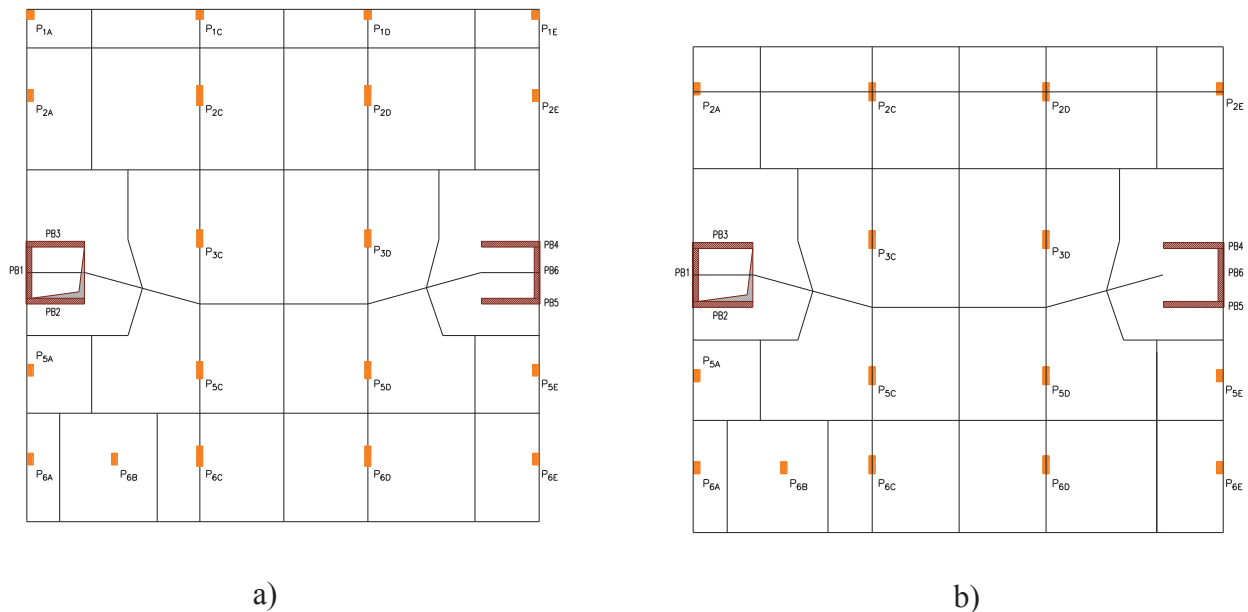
Áreas de influência dos elementos verticais: a) Planta do Piso 1 e b) Planta Piso 2
